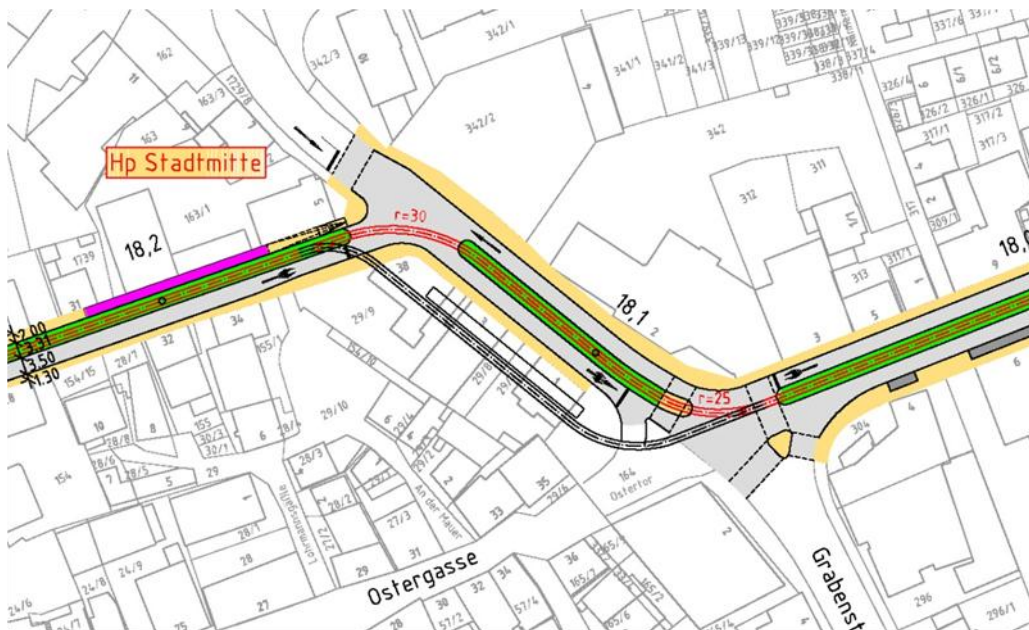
Lageplan Bereich Ostertor, Hp Stadtmitte
